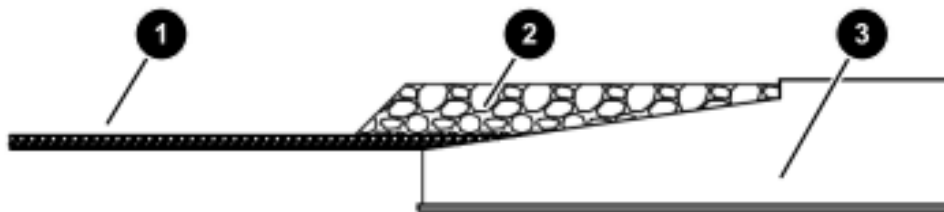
Fundament Teilanschnittung mit Erdauflast
